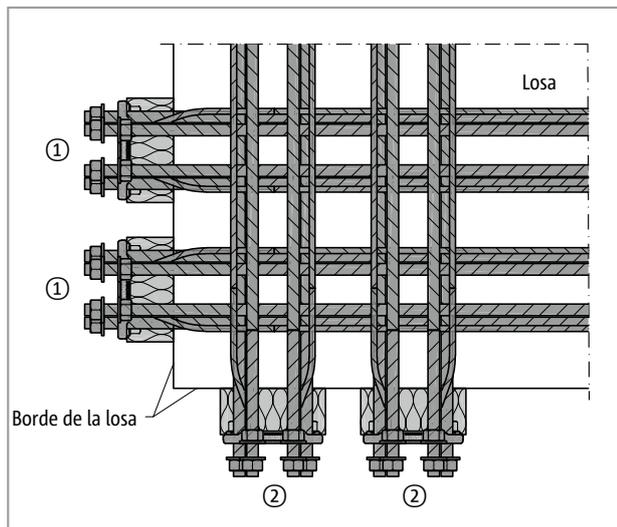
Schöck Isokorb® T tipo SK: Esquinero externo
